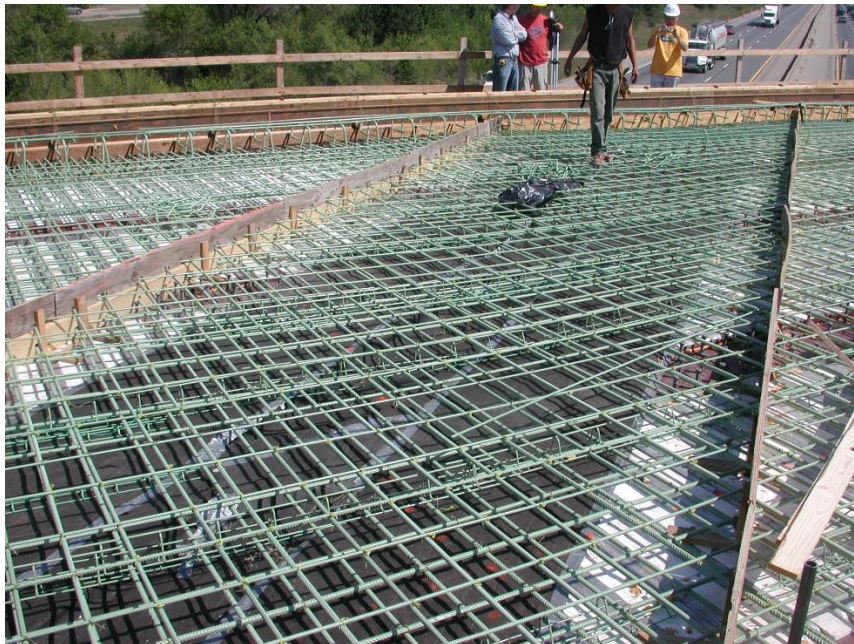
Instalación de acero de refuerzo y encofrado de la losa de enlace
